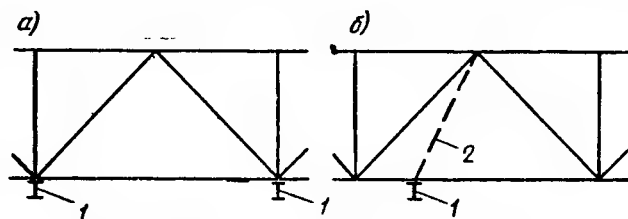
Схемы крепления путей подвешенного транспорта к ферме
